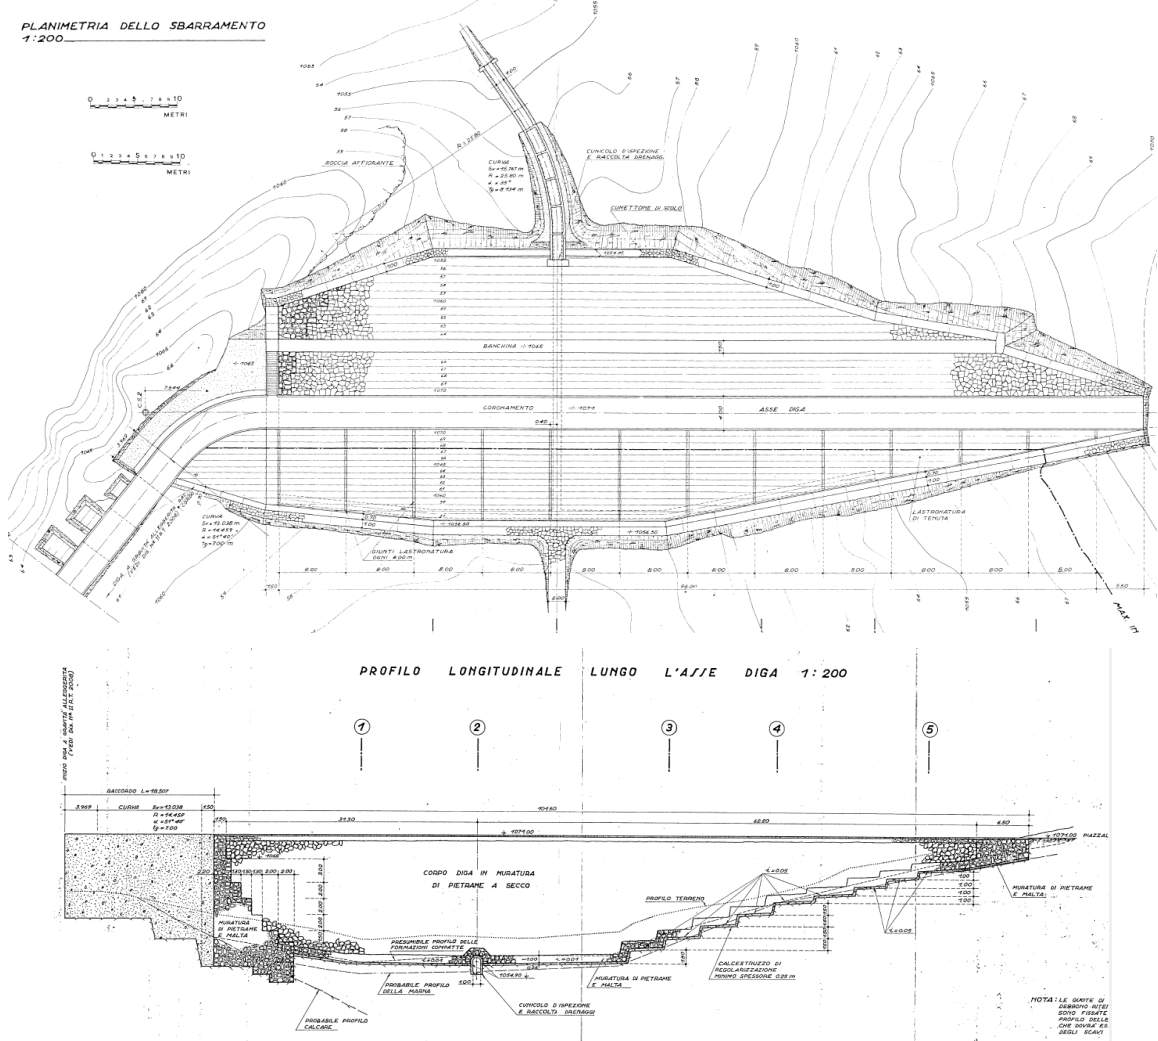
planimetria (sopra) e profilo longitudinale (sotto) della diga secondaria n. 3
